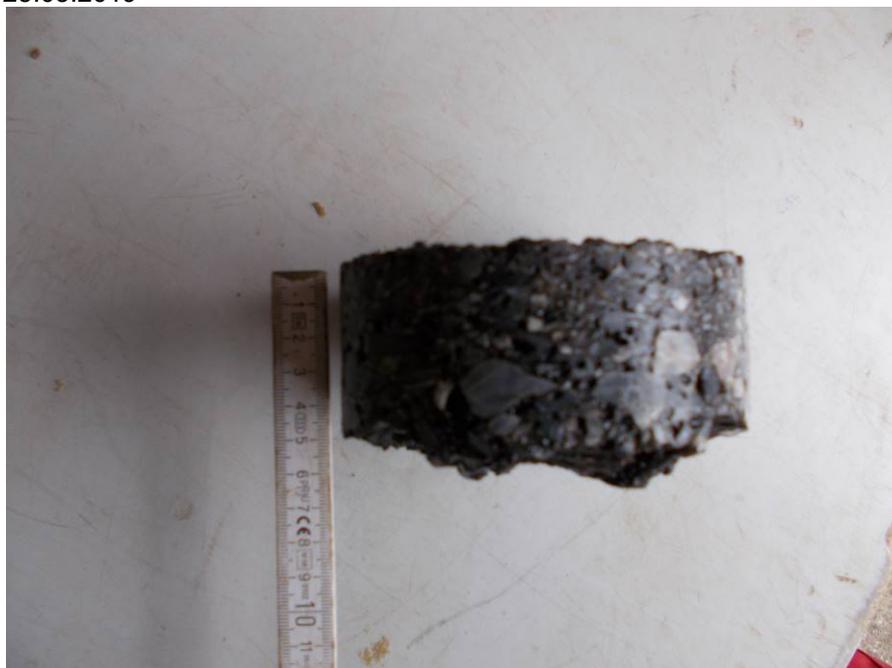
Detailansicht Kern K 3 (0-6 cm)
